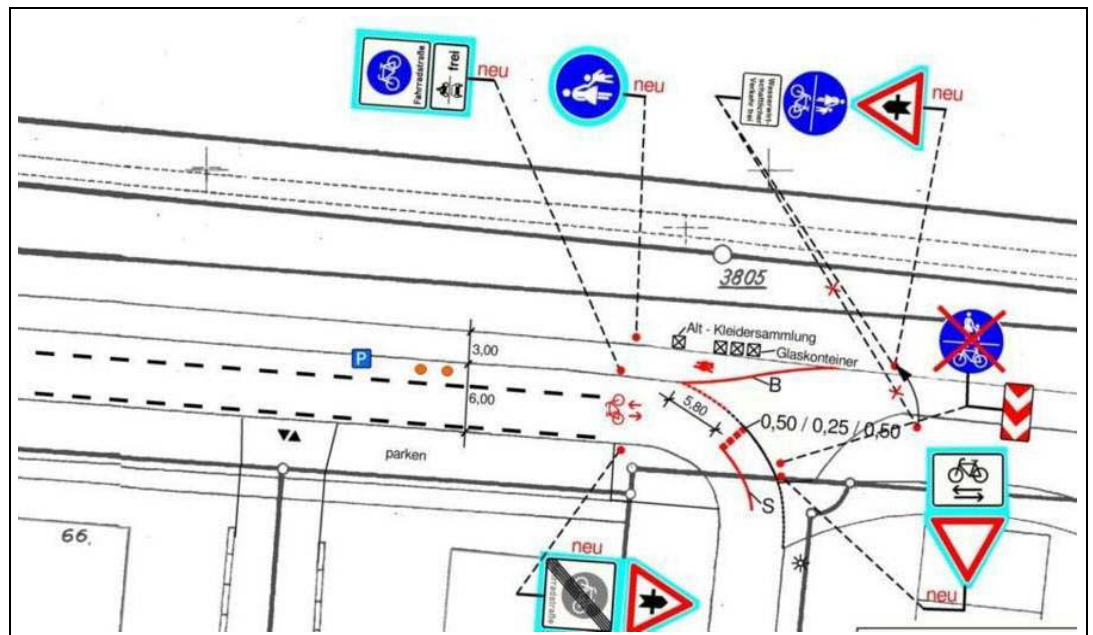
Abschnitt 2 – Planung Bereich Lochmattenstraße
